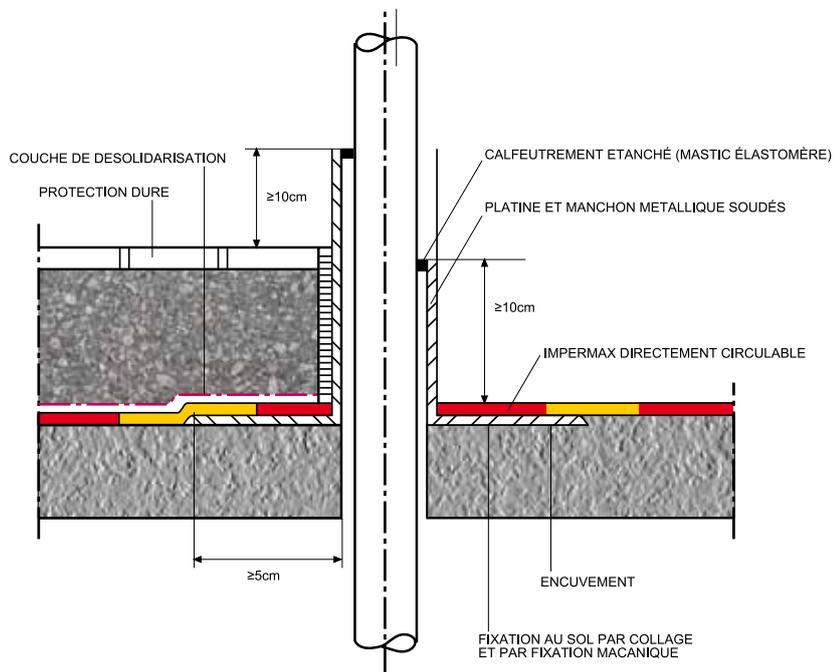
Traversée d'une canalisation sur massif avec fourreau
